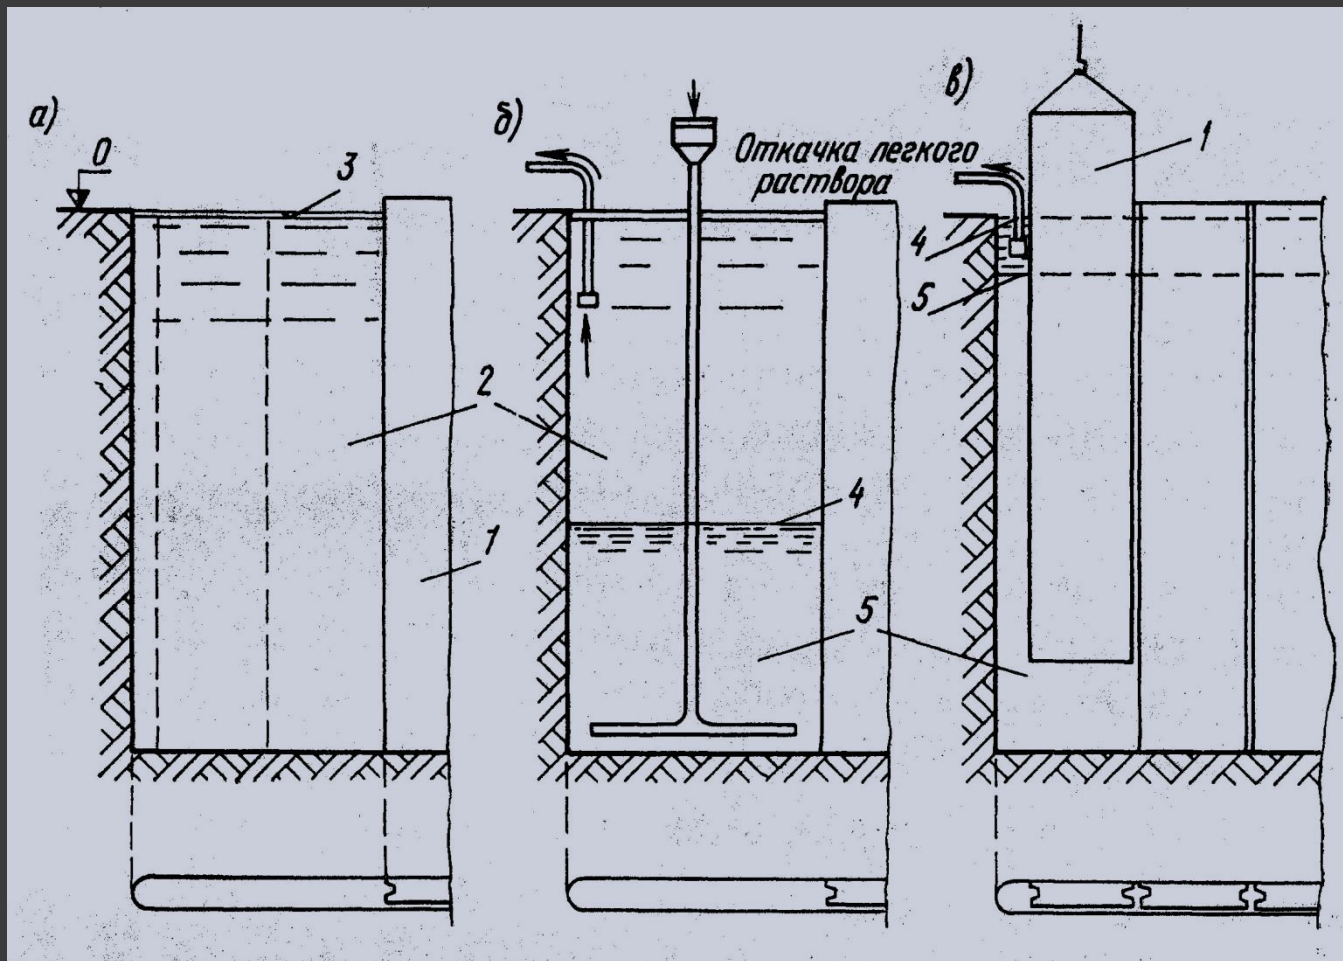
Строительство подземной части сооружения методом "монолитная стена в грунте":
